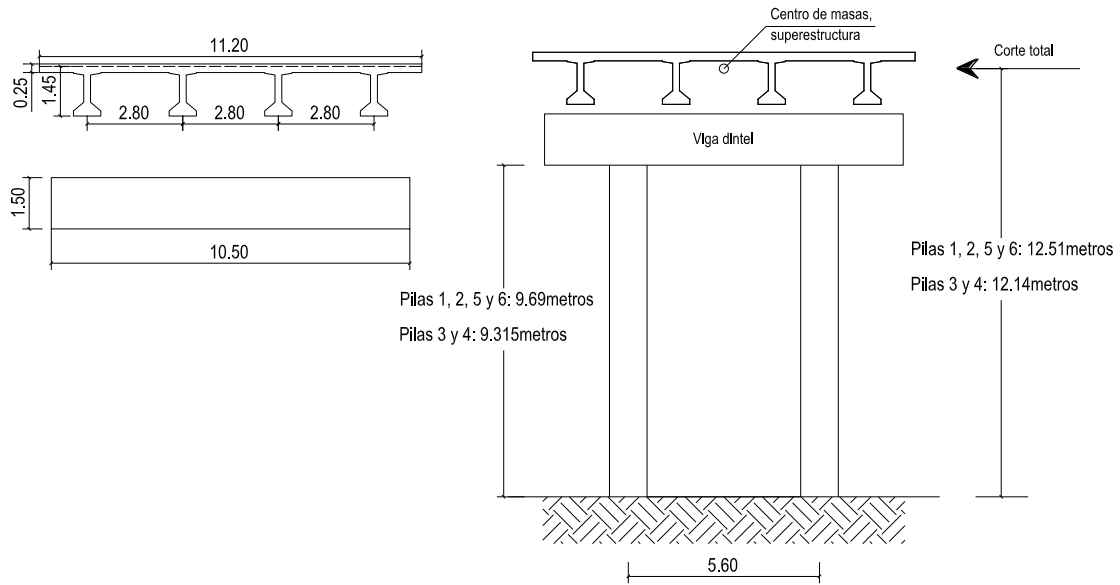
Dimensiones del tablero, viga dintel y altura de pilas del modelo del puente P4
